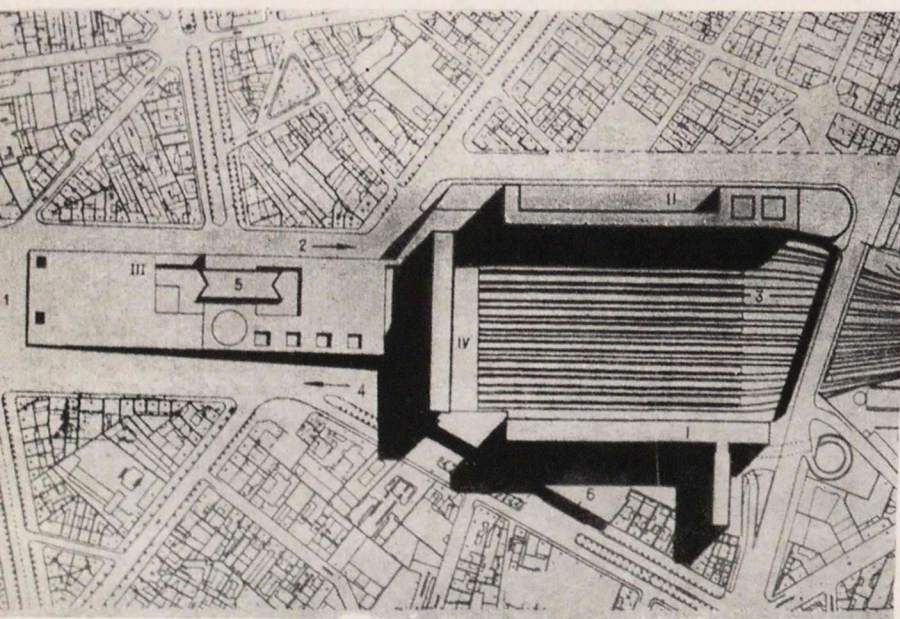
Схема генерального плана вокзала Мен-Монпарнас
